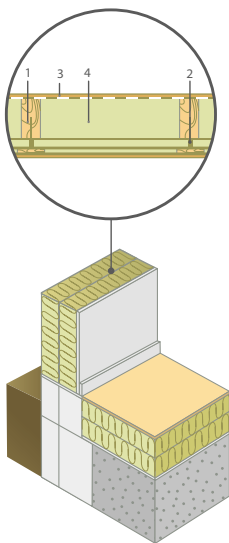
Каркасно-обшивная стена с брусками, прикрепленными к стойкам каркаса:
